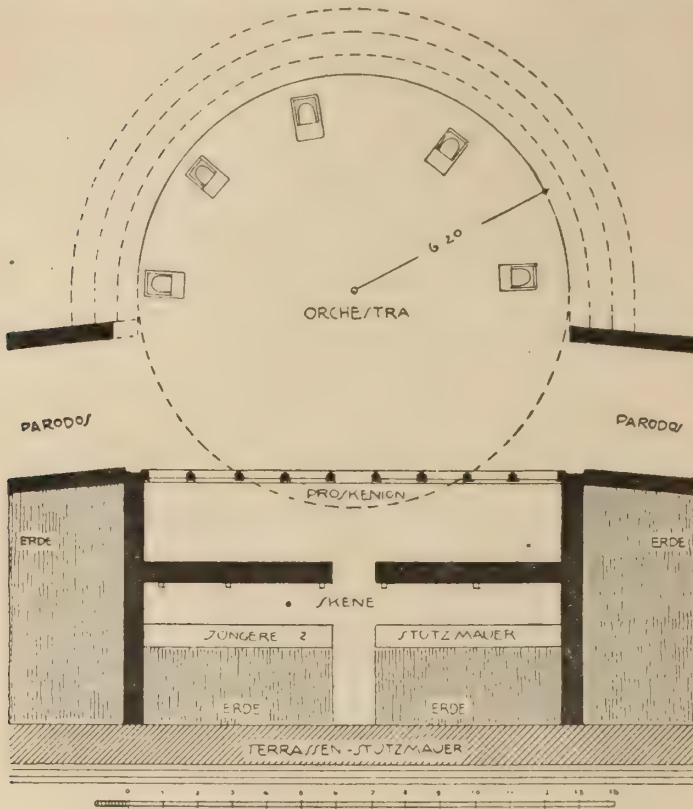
Grundriß des Theaters und Durchschnitt durch das Bühnenhaus von Oropos.
